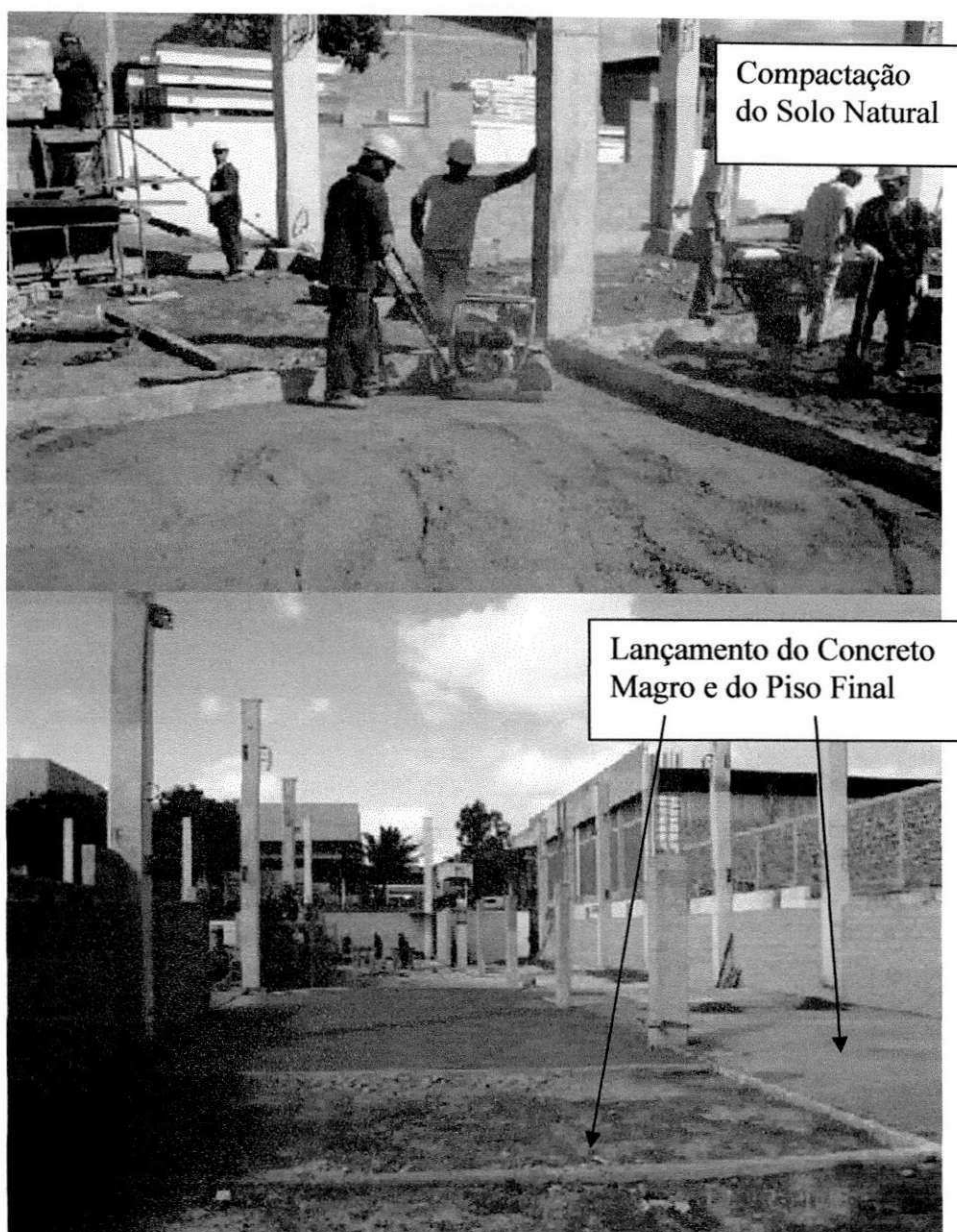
Execução do Contrapiso dos Prédios em Anexo
